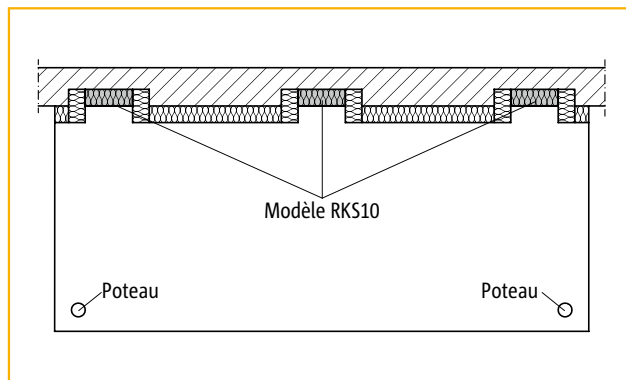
montage d'un balcon sur une dalle existante avec modèle RKS10, construction soutenue
